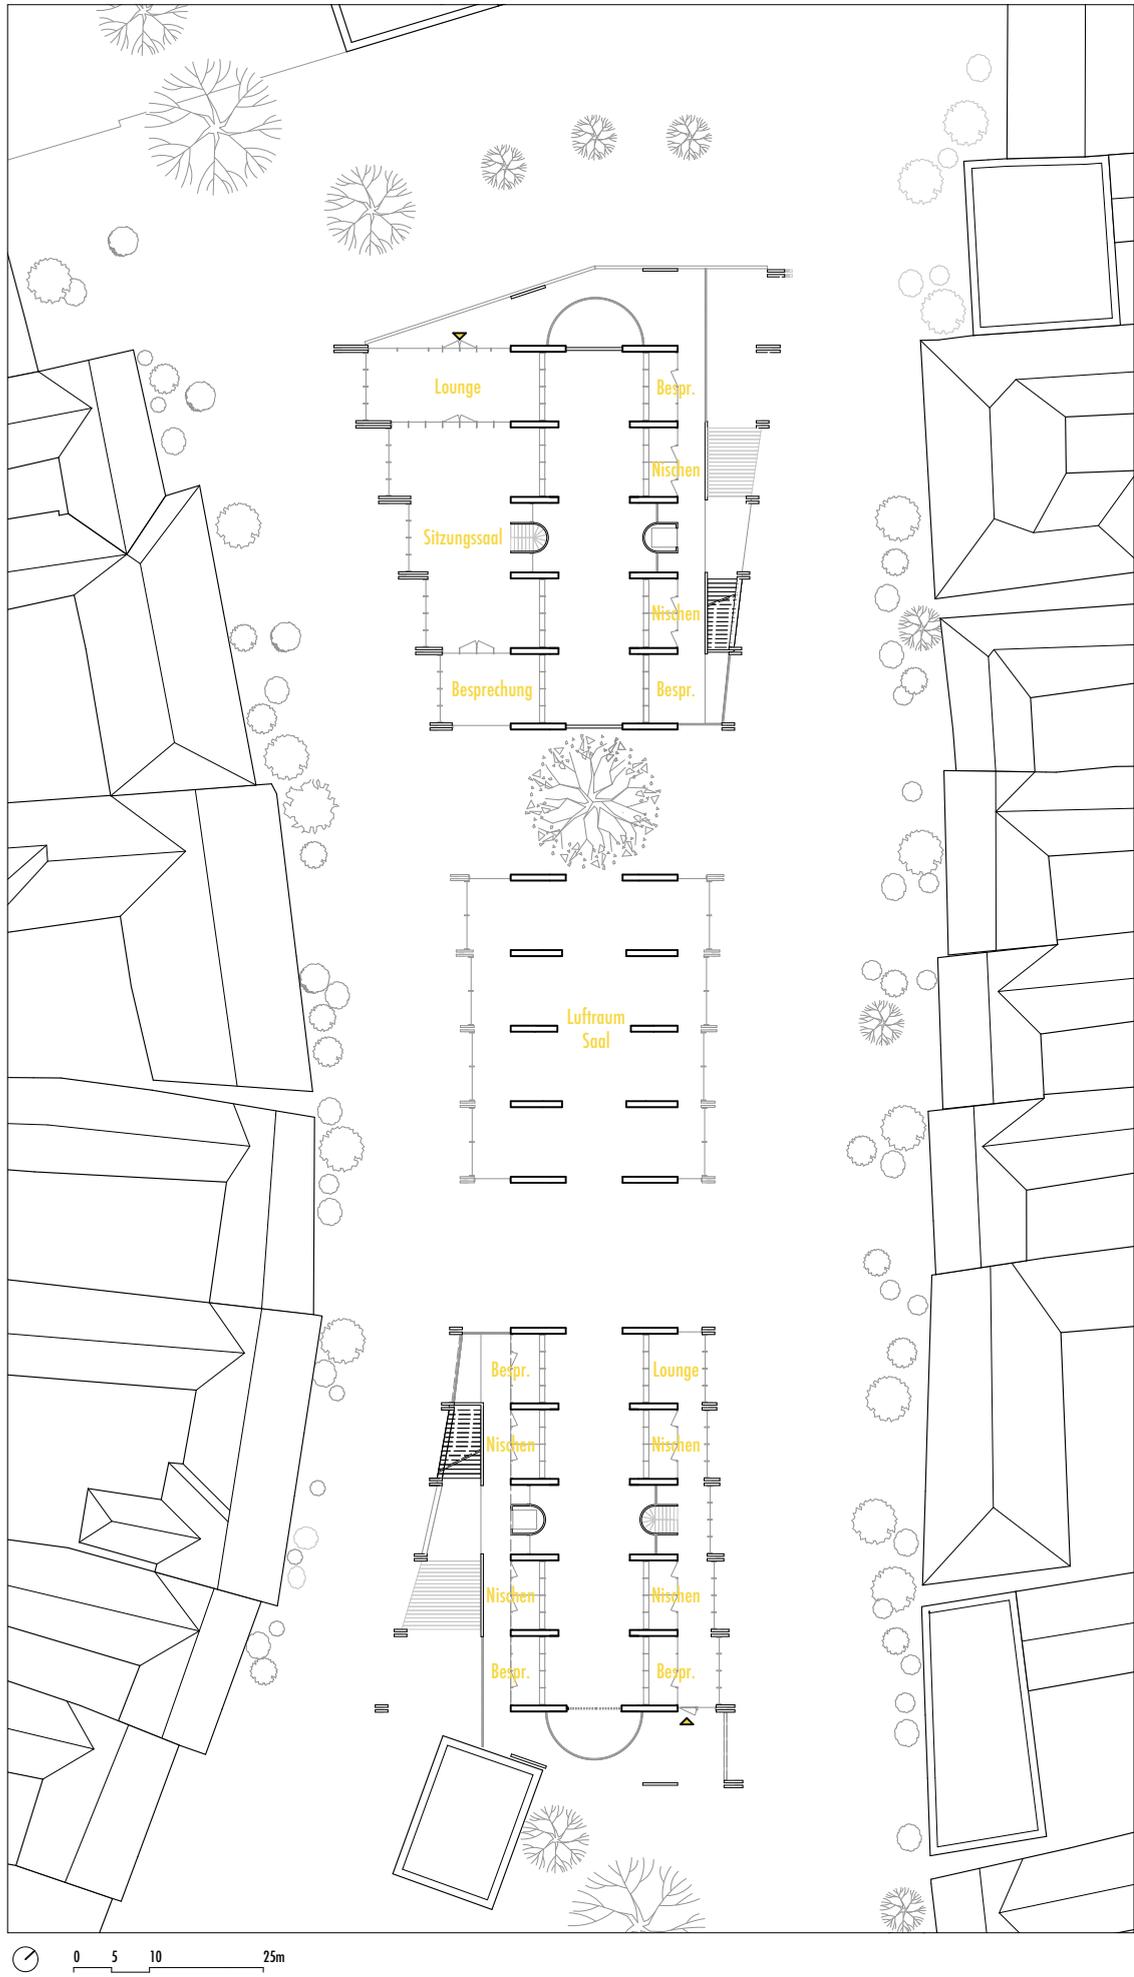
Grundriss Erdgeschoss DSM, Maßstab 1:333.
